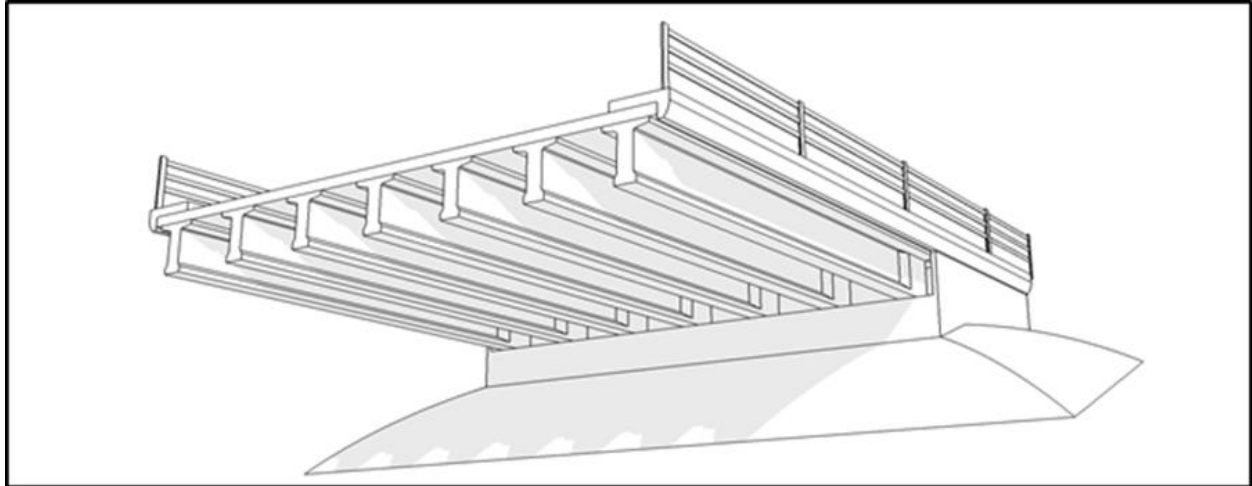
Morphologie générale d'un pont à poutres type VIPP
